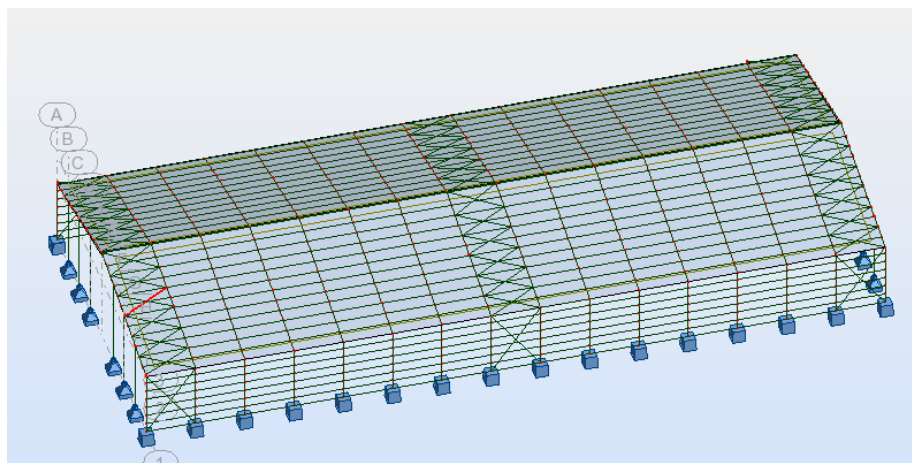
La diagonale la plus sollicitée de la poutre au vent
